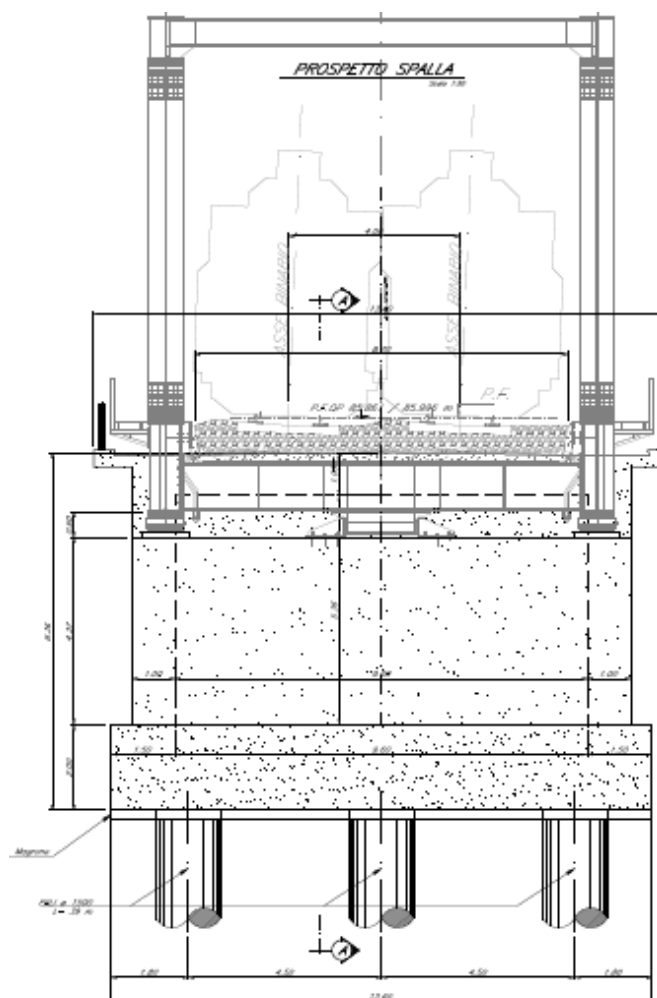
Prospetto spalla Ponte sul Naviglio Pavese
